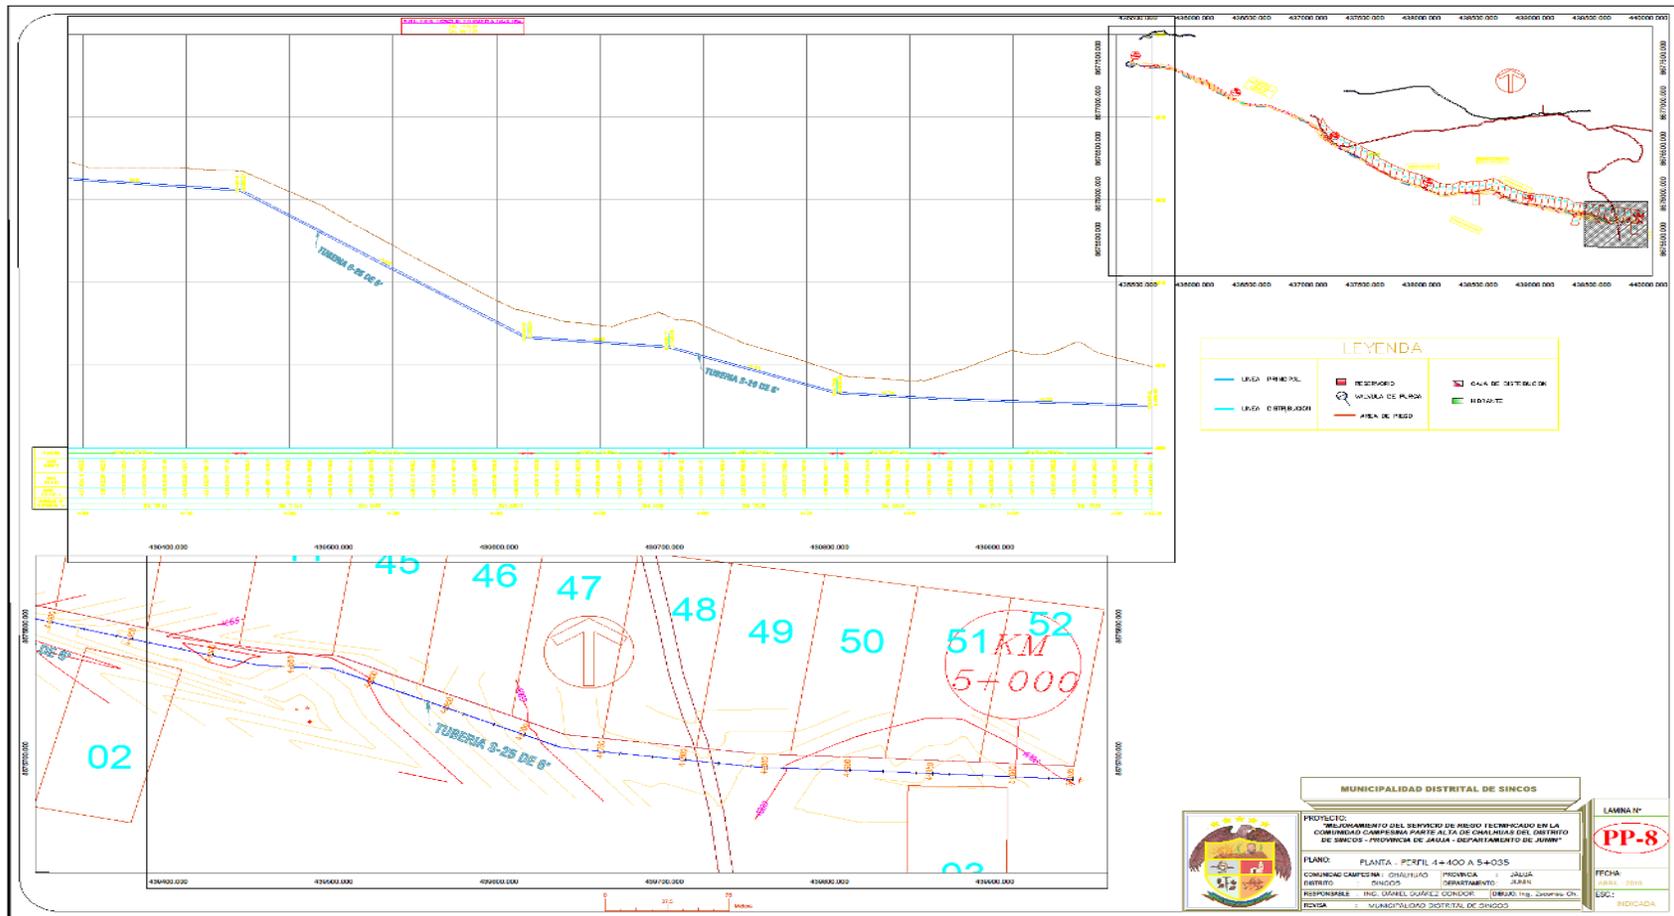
Plano de planta - perfil de canal Prog. 4+400 a 5+035.
